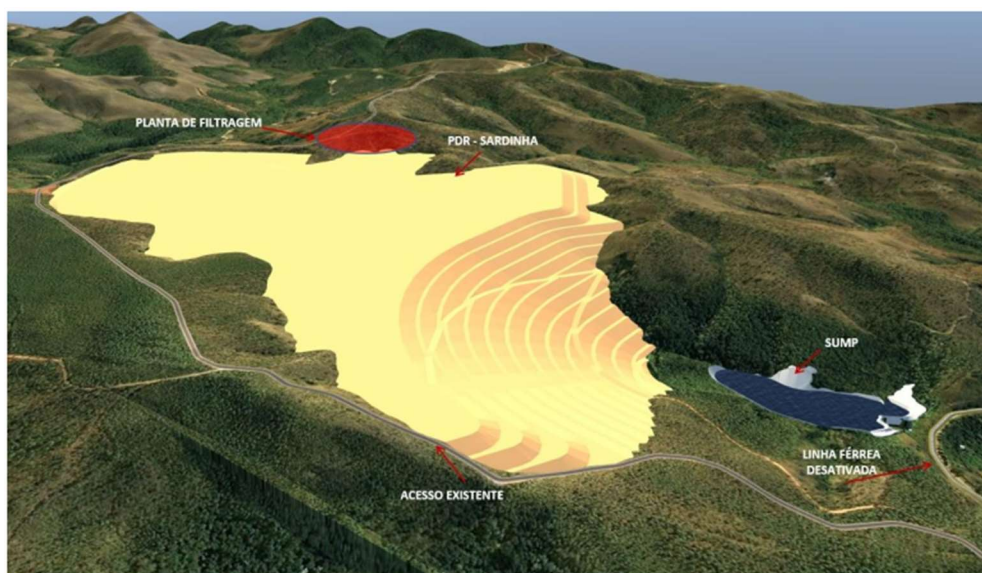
Visão geral da pilha. Fonte: EIA, 2020.
